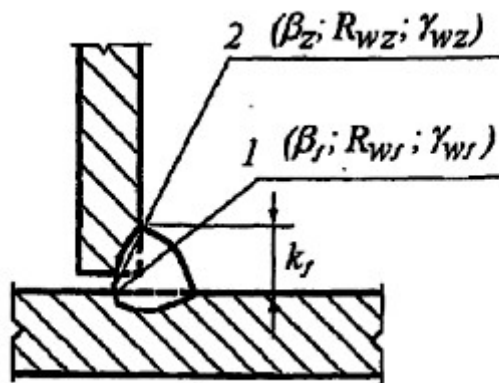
Схема расчетных сечений сварного соединения с угловыми швами: 1 – по металлу шва; 2 – по металлу границы сплавления.
